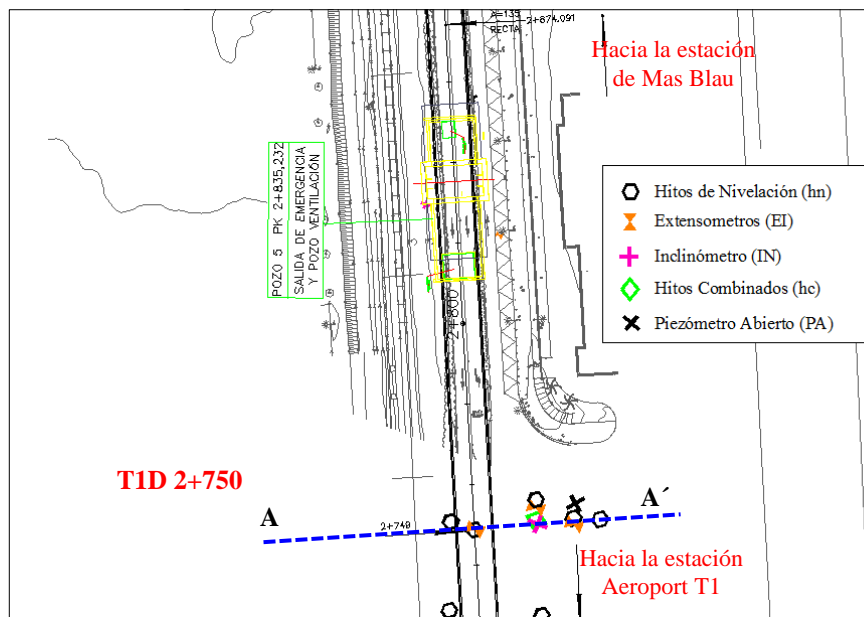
3. Situación en planta del túnel y la sección de control T1D PK 2+750
